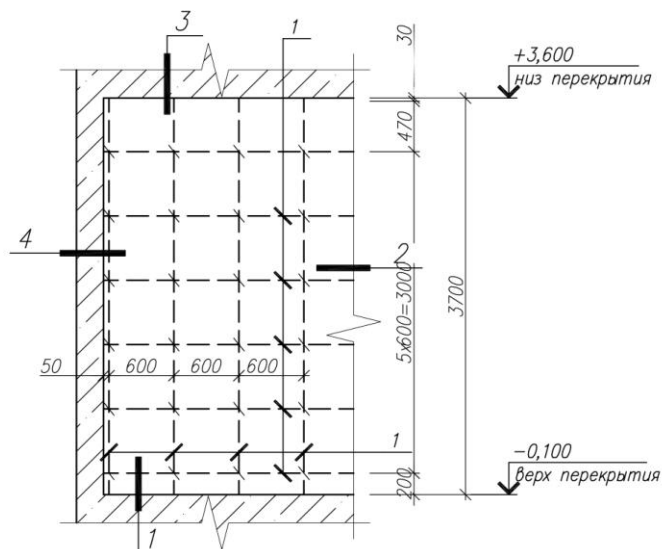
Схема узла перегородок 1-го этажа из керамзитобетонных блоков толщиной 100мм
